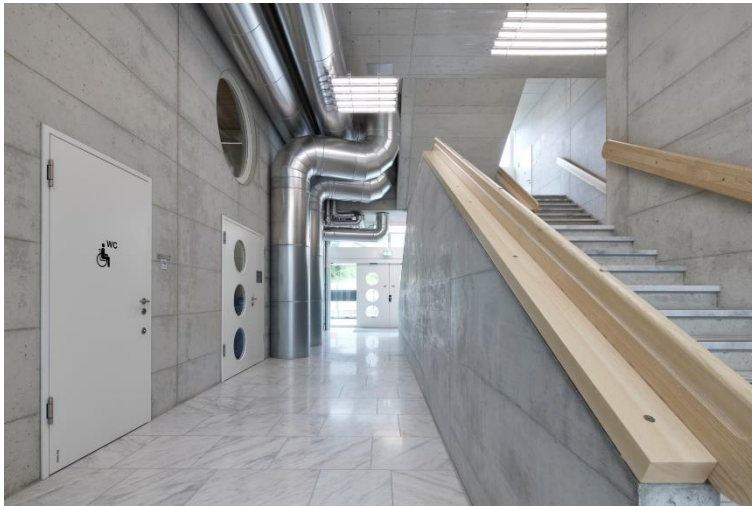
Roper Beton und sichtbare Technik prägen die Verkehrsflächen.
